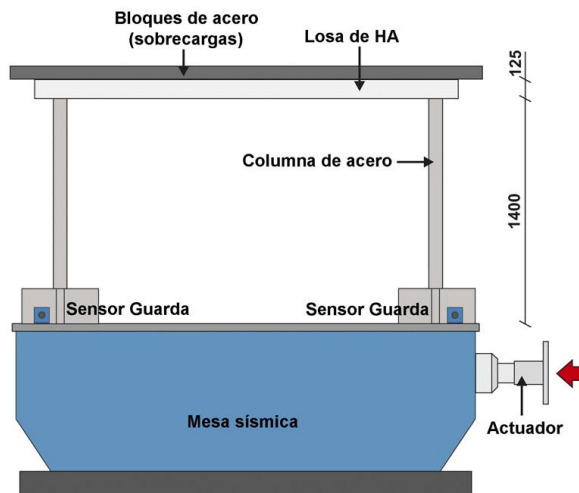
Ubicación de los sensores guarda en el modelo de ensayo de la losa con pilares metálicos.
